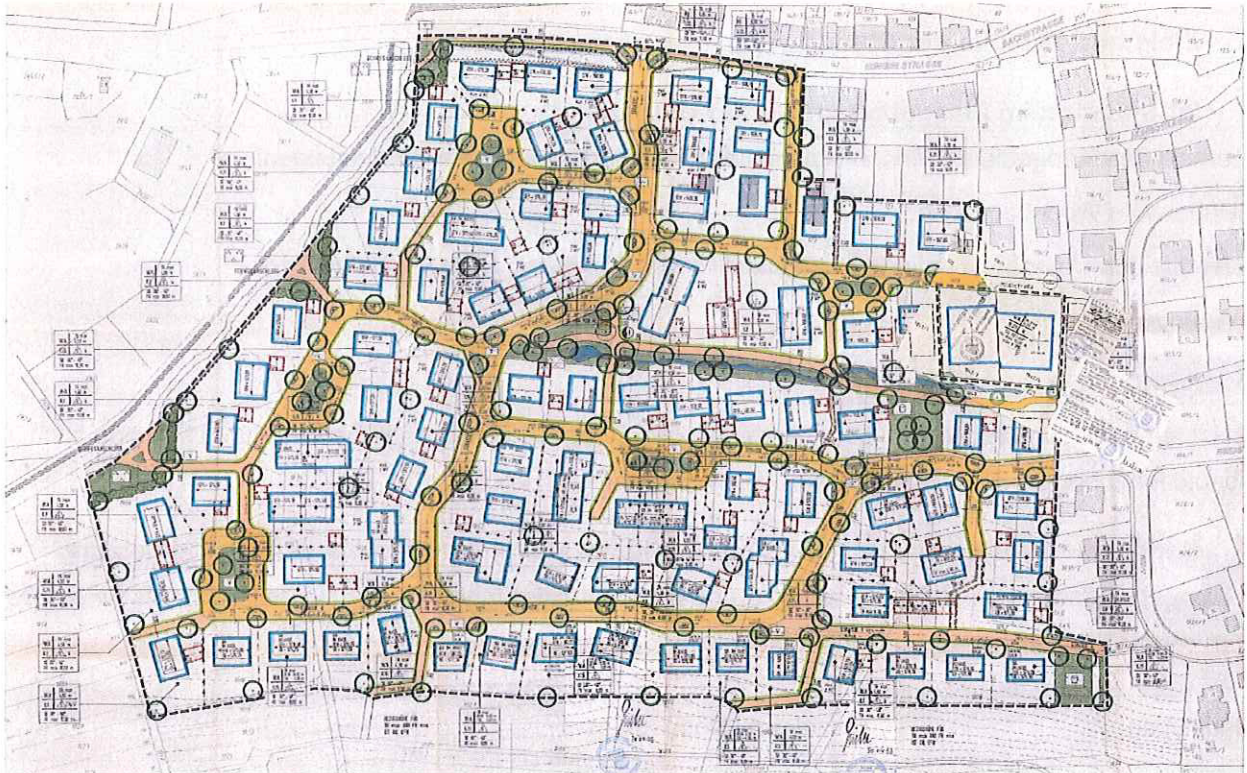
Rechtskräftiger Bebauungsplan „Hung II“
